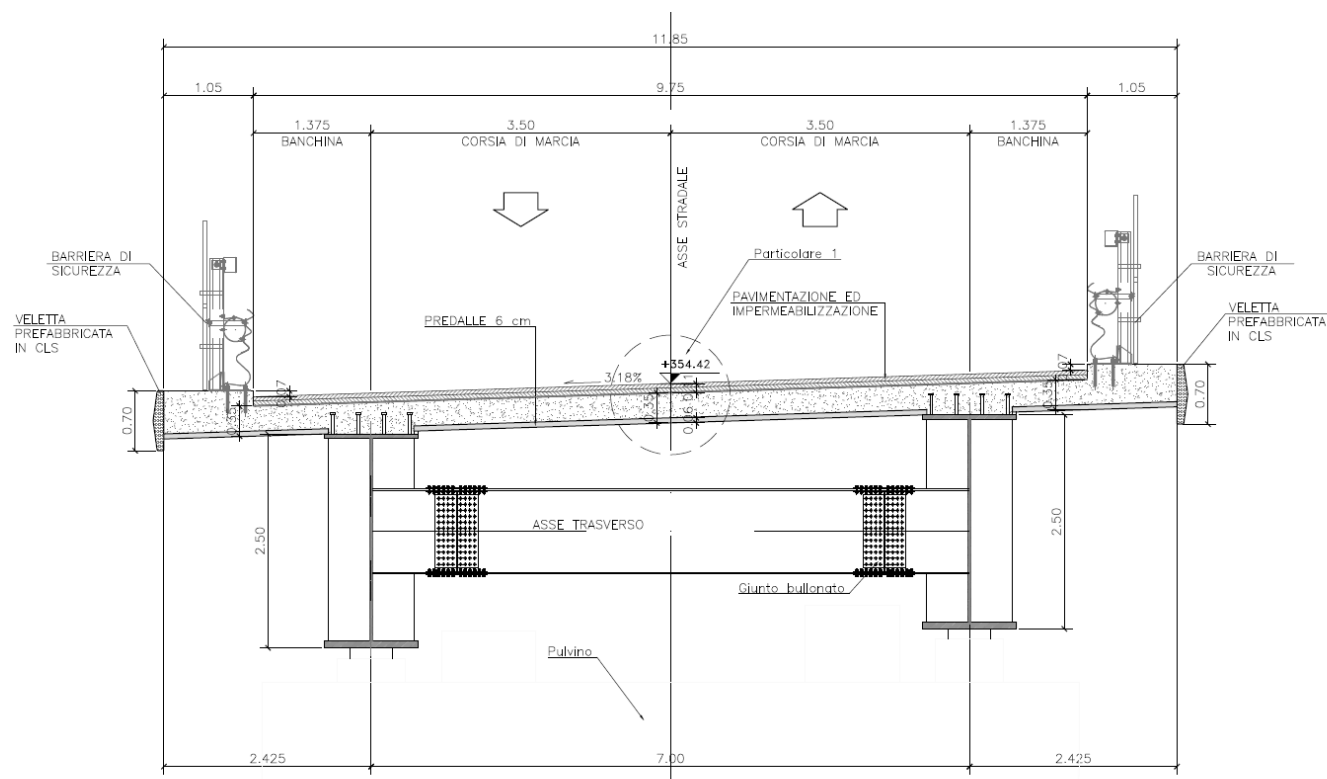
Sezione Trasversale dell'impalcato del Viadotto Marroggia 1.
